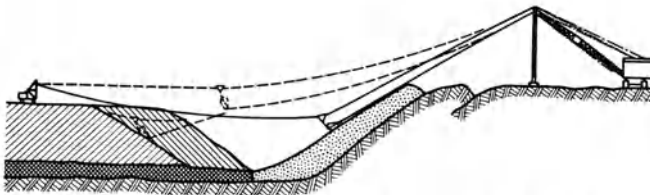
Universal-Raupenbagger als Kabelbagger arbeitend (Sauerman).
